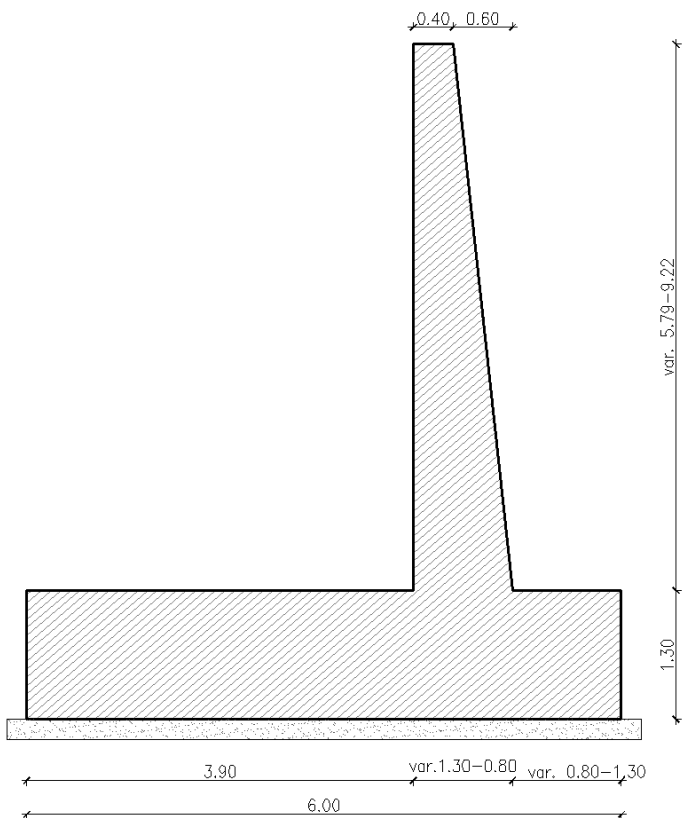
Sezione Muro – prosecuzione spalla altezza variabile
